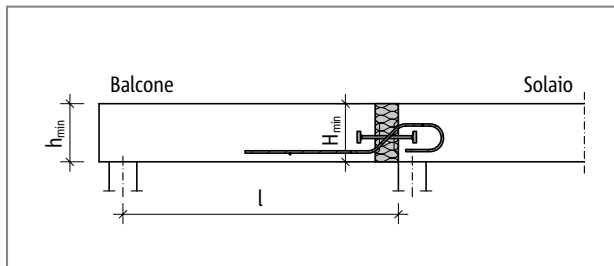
Schöck Isokorb® tipo QP20S e QP50M: schema statico
